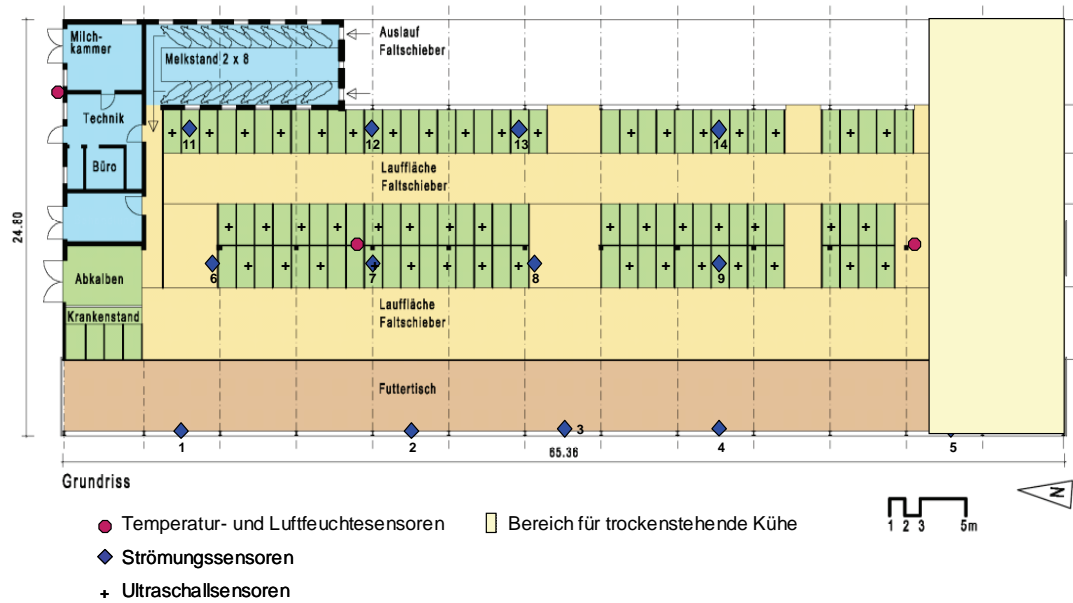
Grundriss des Betriebes A und Verteilung der Sensoren
